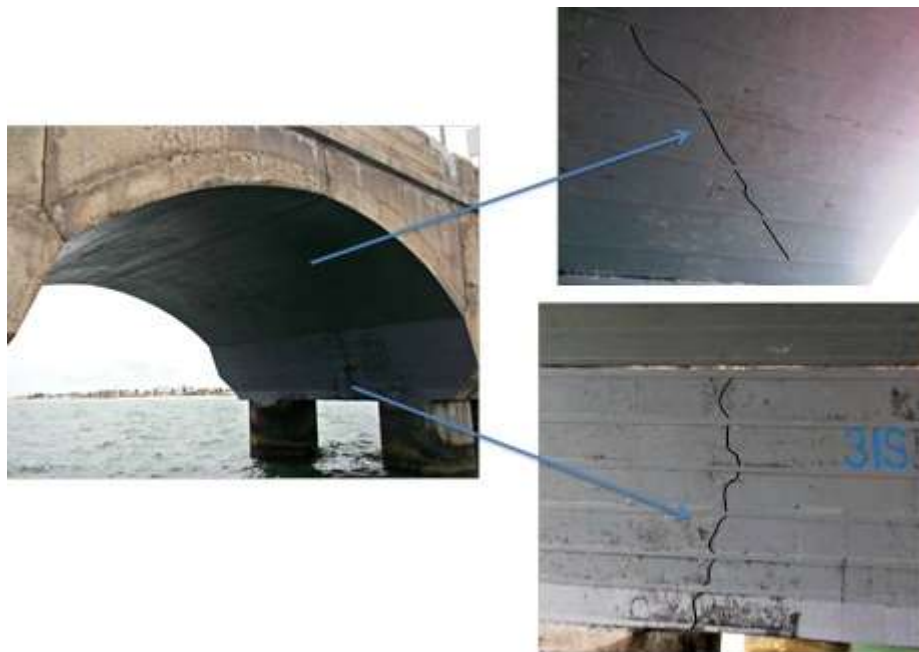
Fisuras encontradas en la inspección 2013 en el apoyo 30
